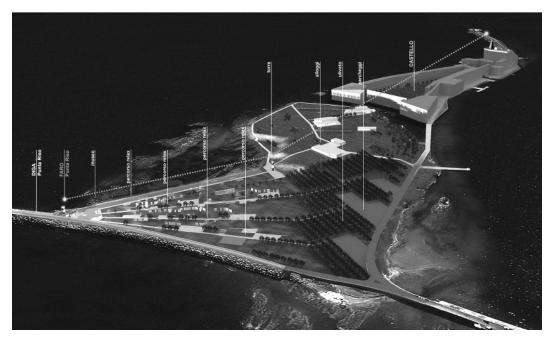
Planimetría general del proyecto de la isla de Sant'Andrea.
